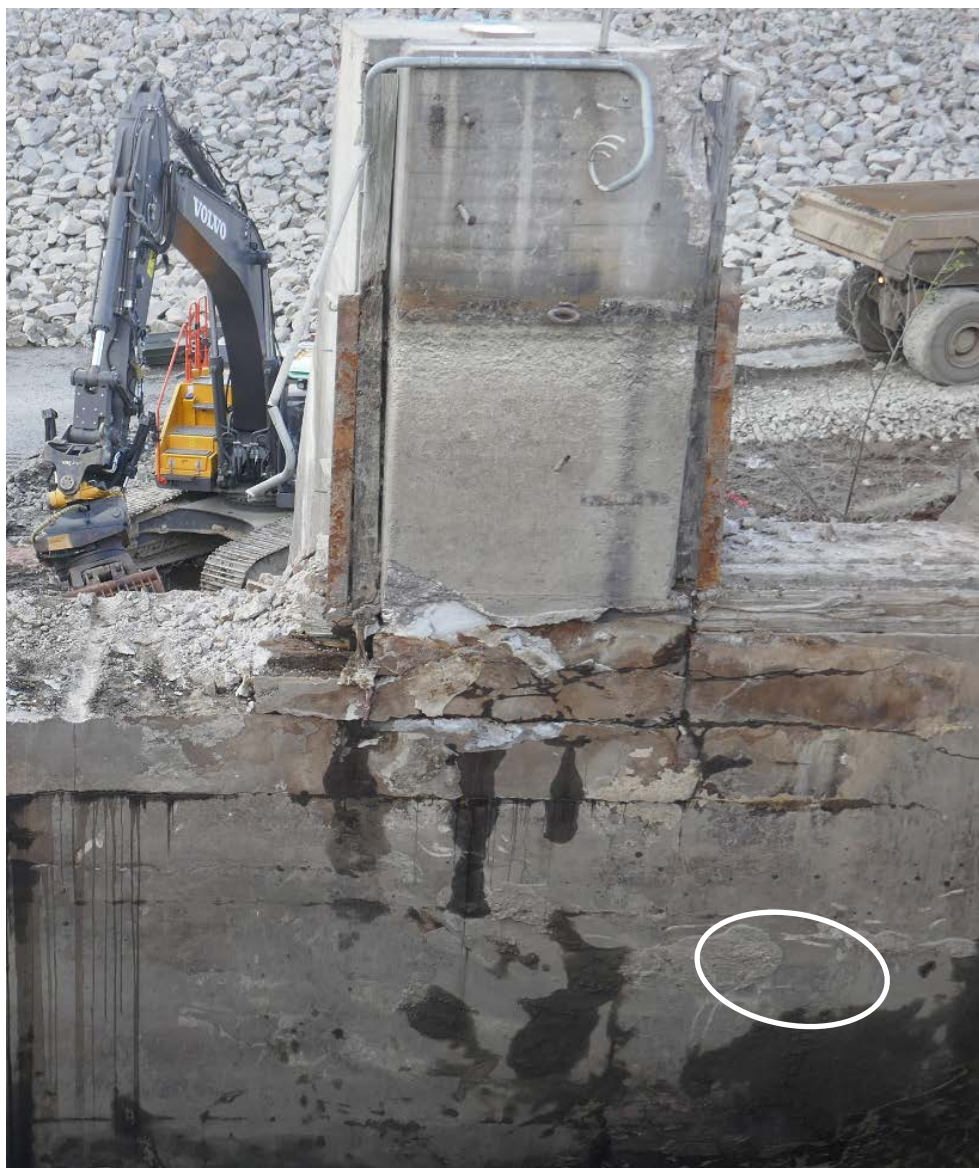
Friläggning av vingmuren som utgjorde del av anslutningen mellan betong- och jorddamm.
